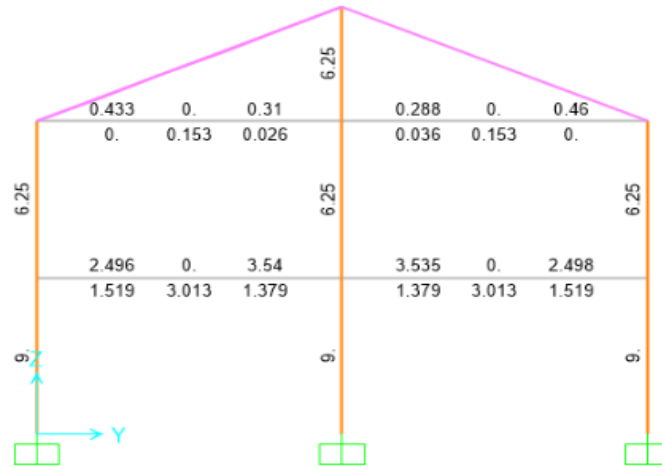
Acero de refuerzo del pórtico central [Autores]
